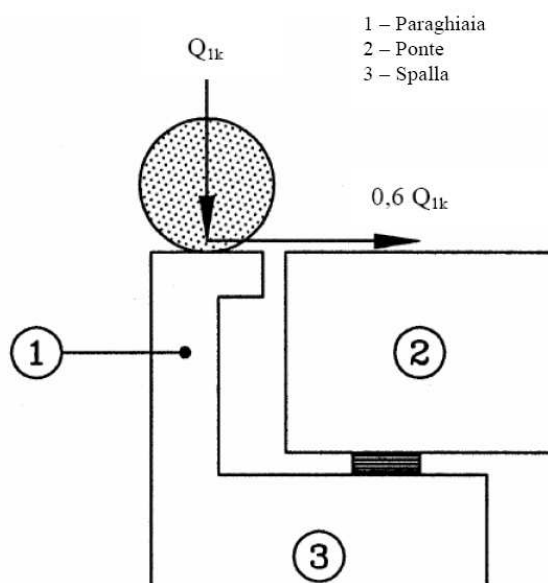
Carichi da traffico su muri paraghiaia
